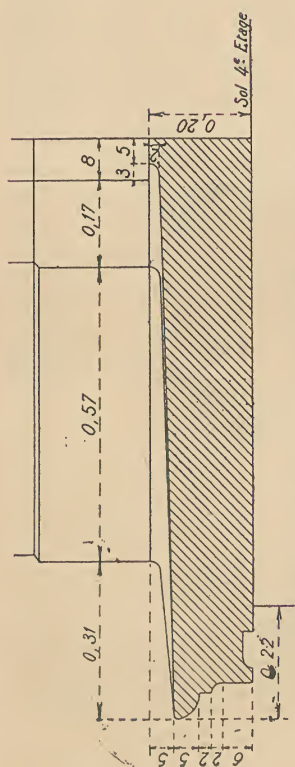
Coupe du balcon du 4° étage suivant HH.
